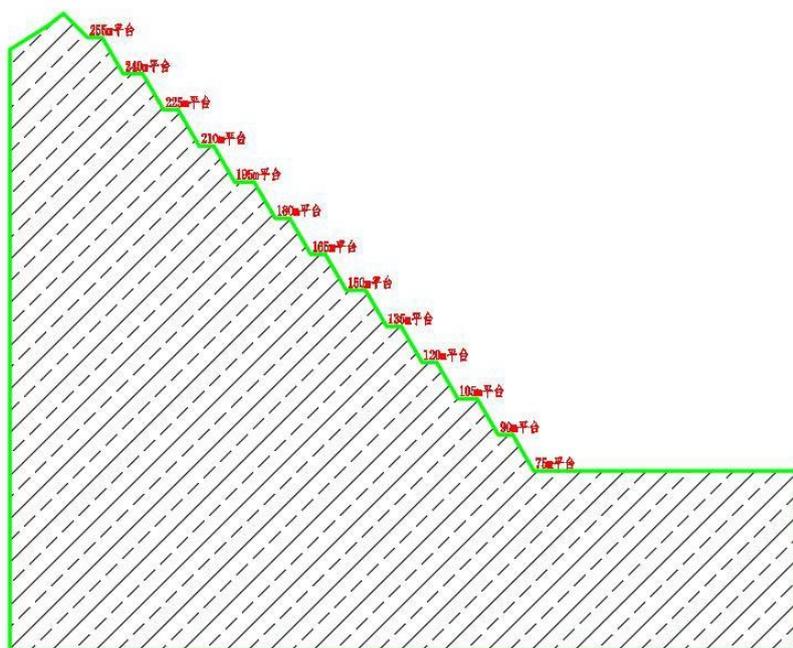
南侧F区最高终了边坡 F-F' 终了坡面图
